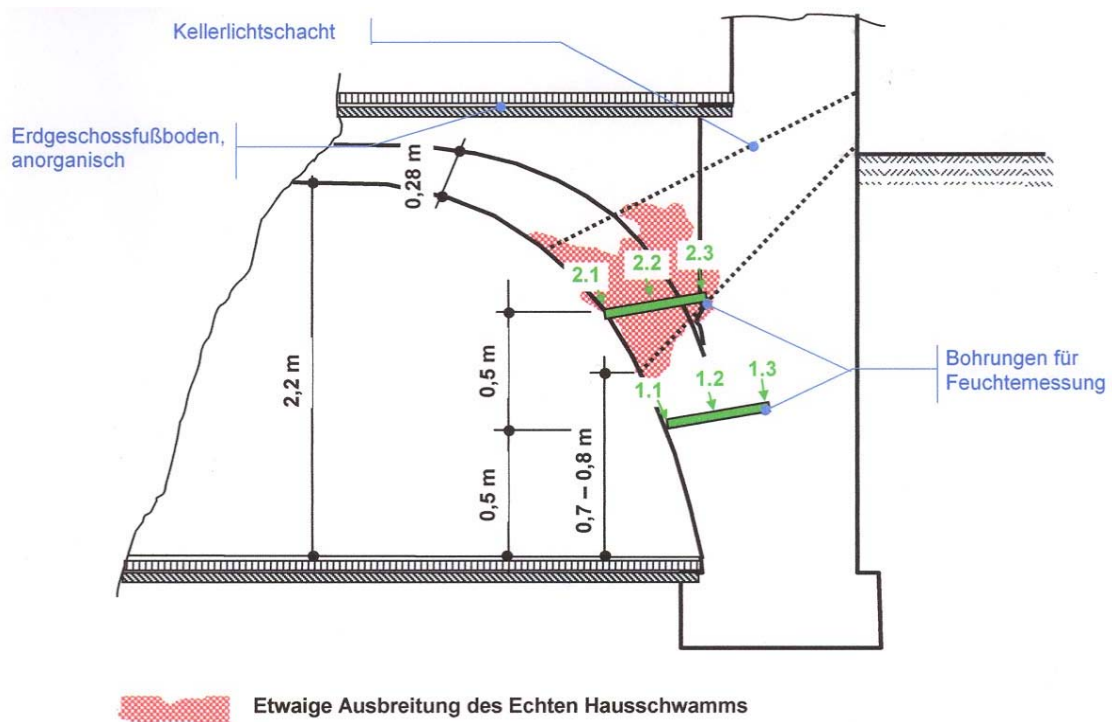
Querschnitt Kellergewölbe mit Anordnung der Bohrungen für Feuchtemessung und Schwammbefall.
